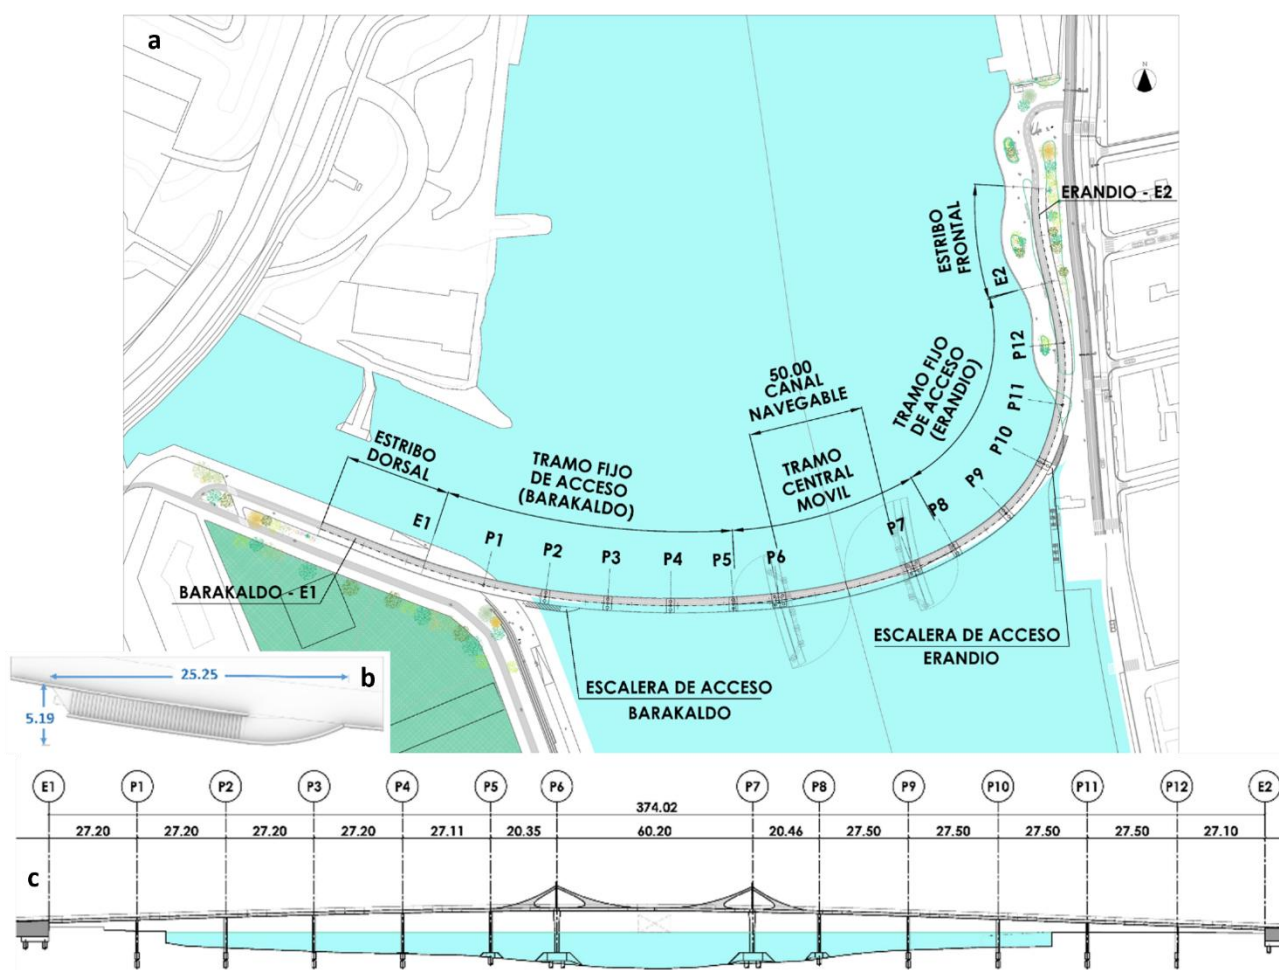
a) planta del puente, b) diseño final escaleras, c) alzado
